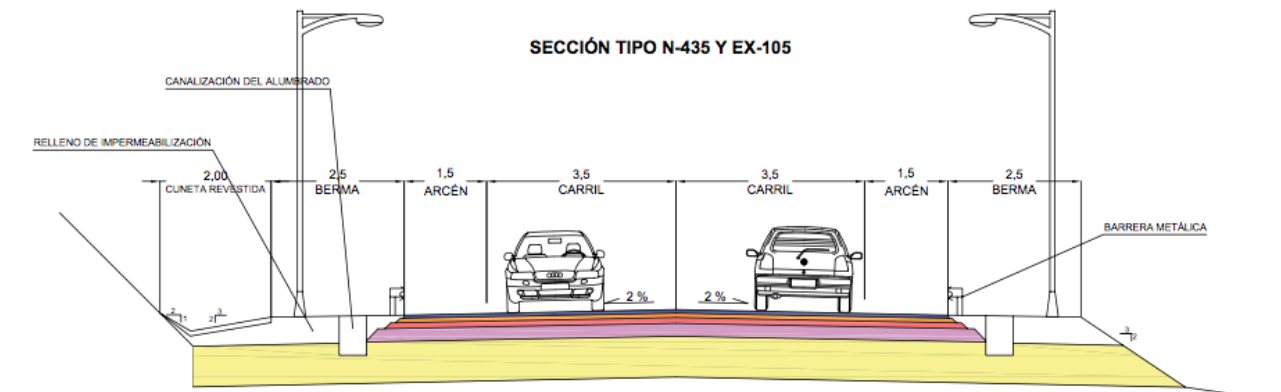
Sección tipo de N-435 y EX-105. Elaboración propia con AutoCad.
